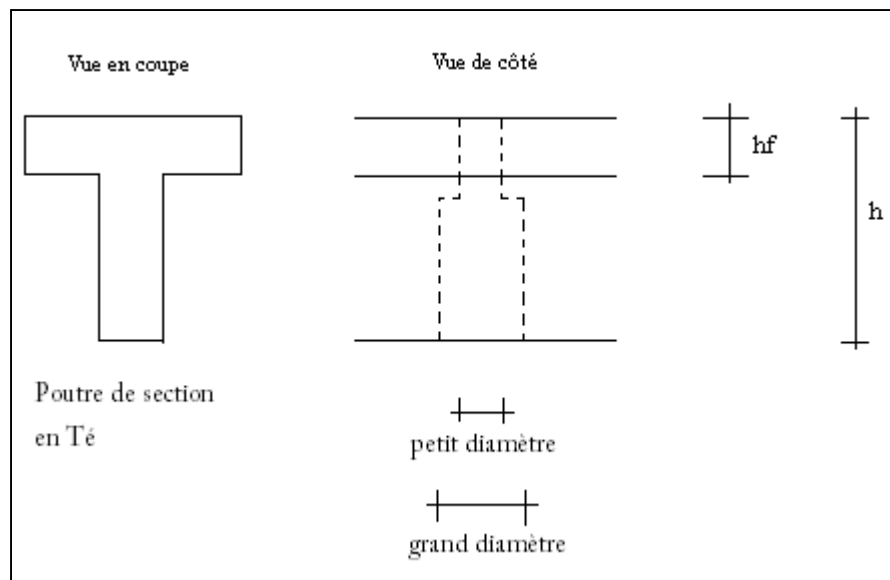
Vue en coupe d'un trou percé au sein de la poutre.
